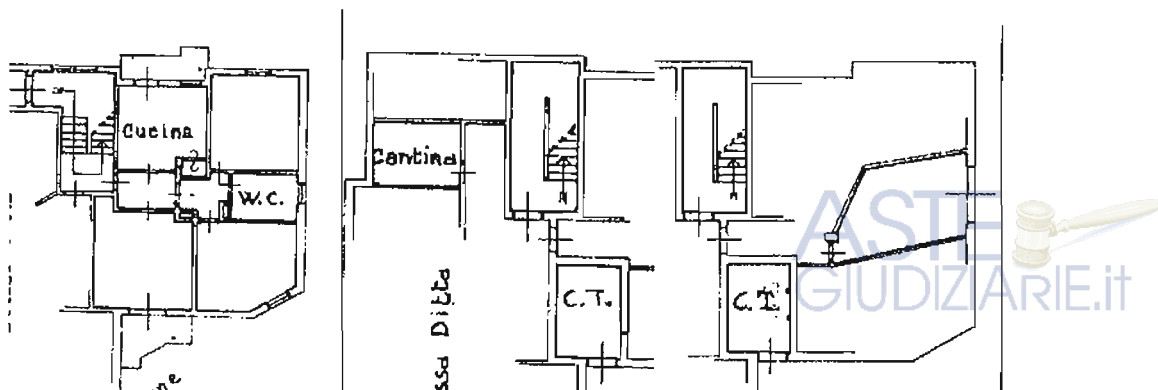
estratti planimetrici dalla planimetria catastale in atti (elaborato non in scala)
